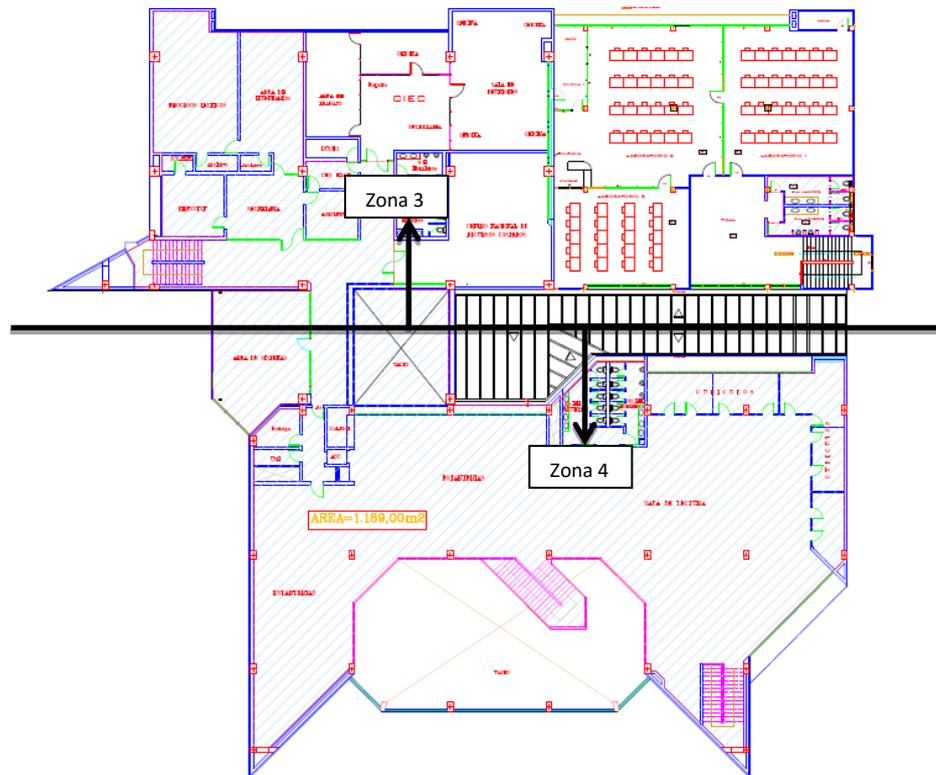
Planos, Planta Alta, Zona 3 y 4
